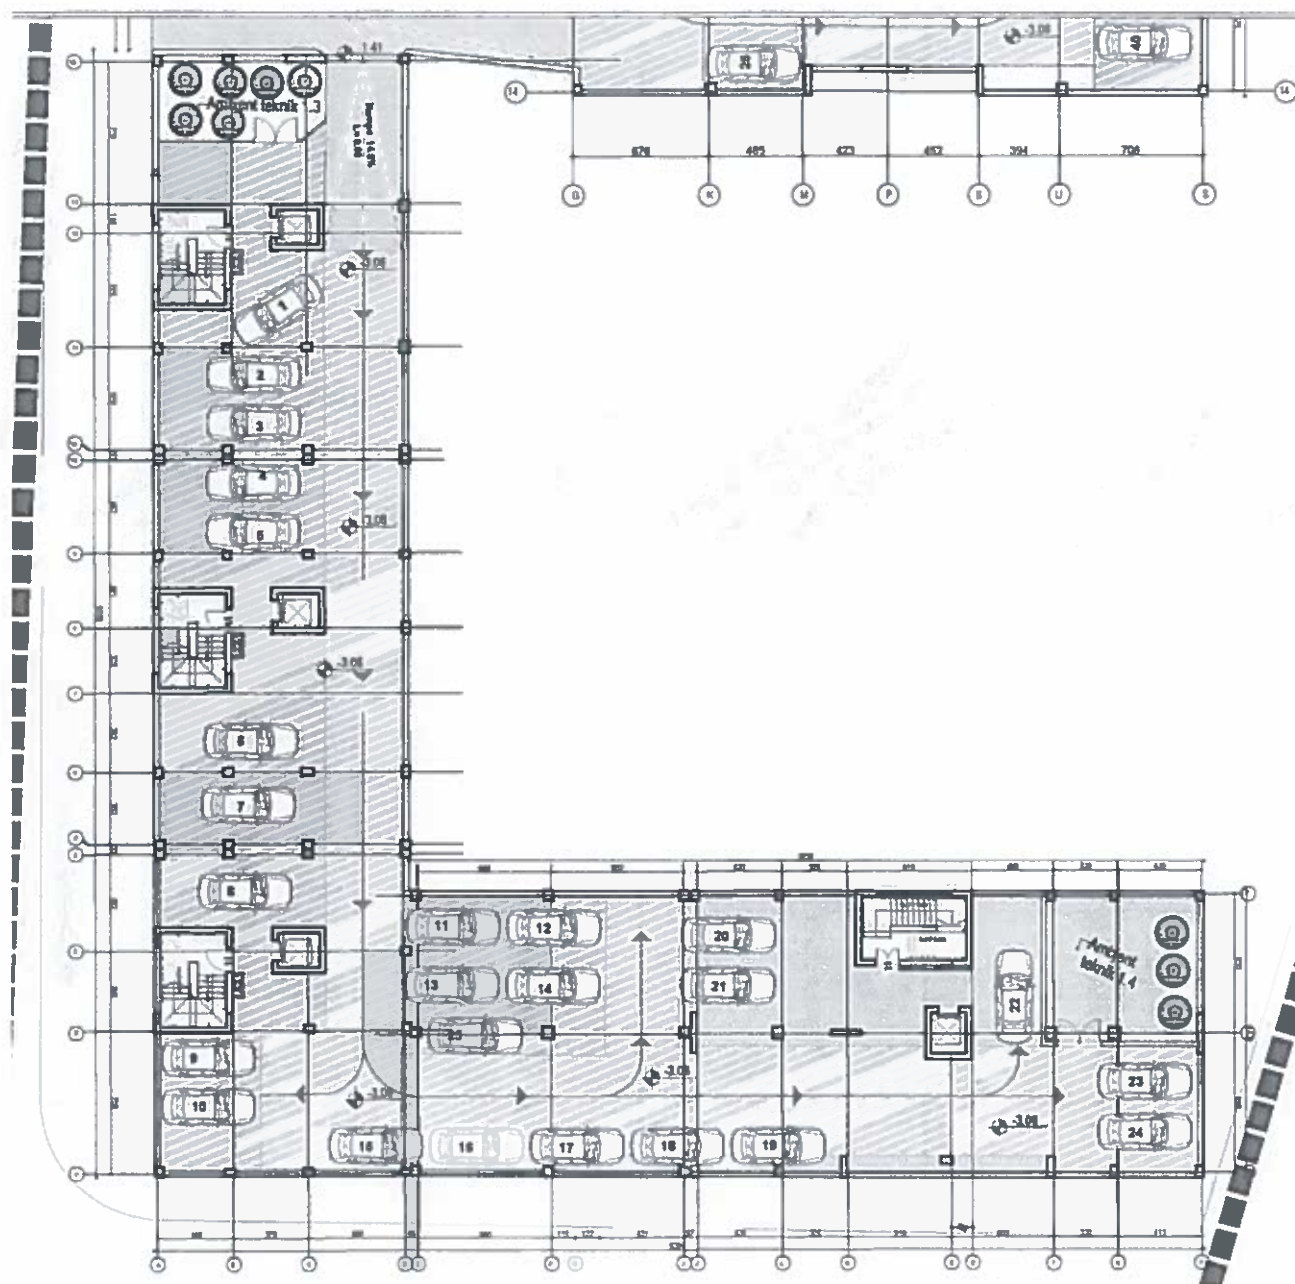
Planimetria e katit -I – Objekti 1.3 dhe 1.4
